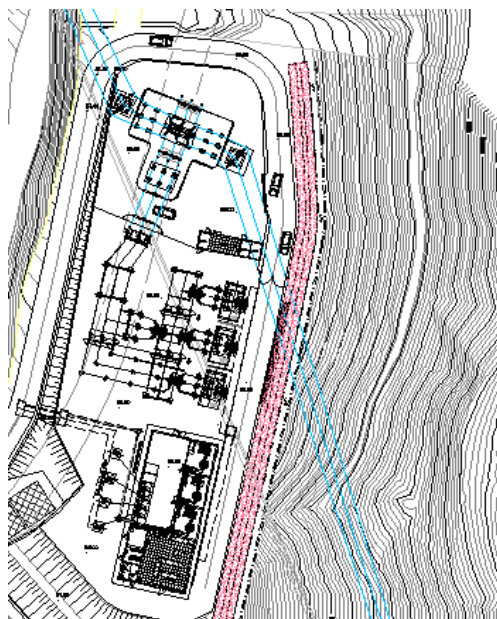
WBS IN21 – Stralcio planimetrico del piazzale
